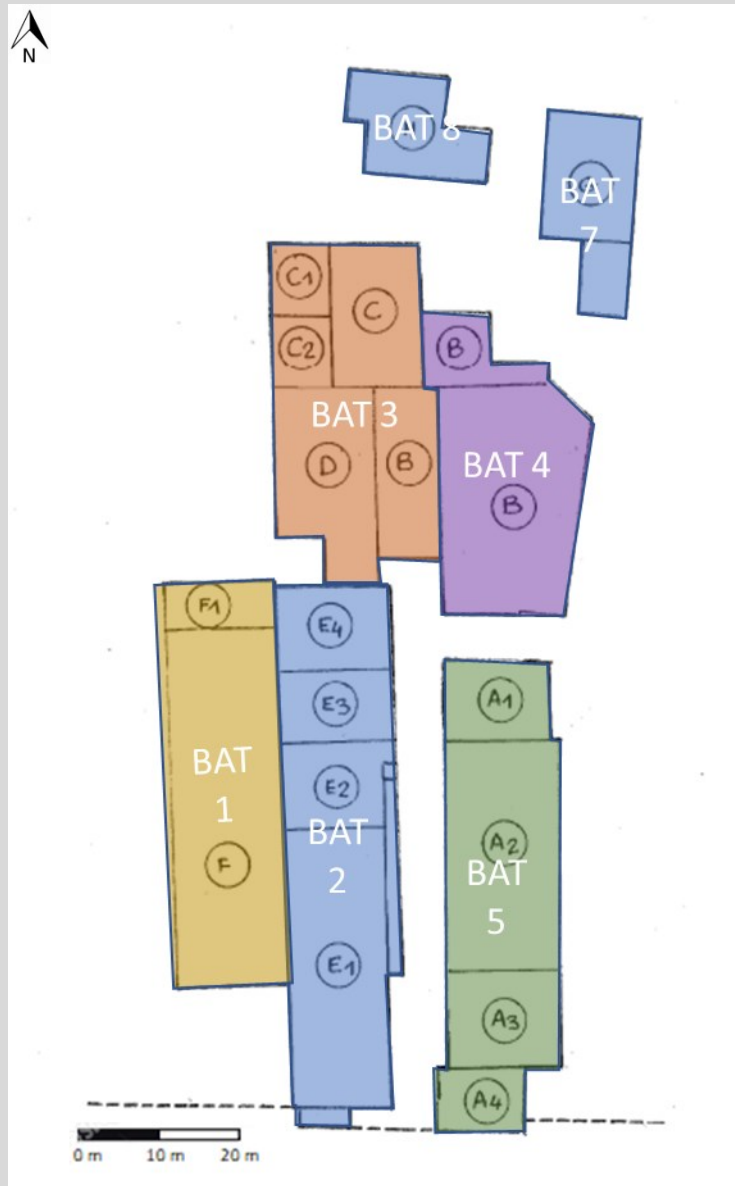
Plan des bâtiments, correspondance chiffres/lettres (Source SUEZ et DIAGTIM)
